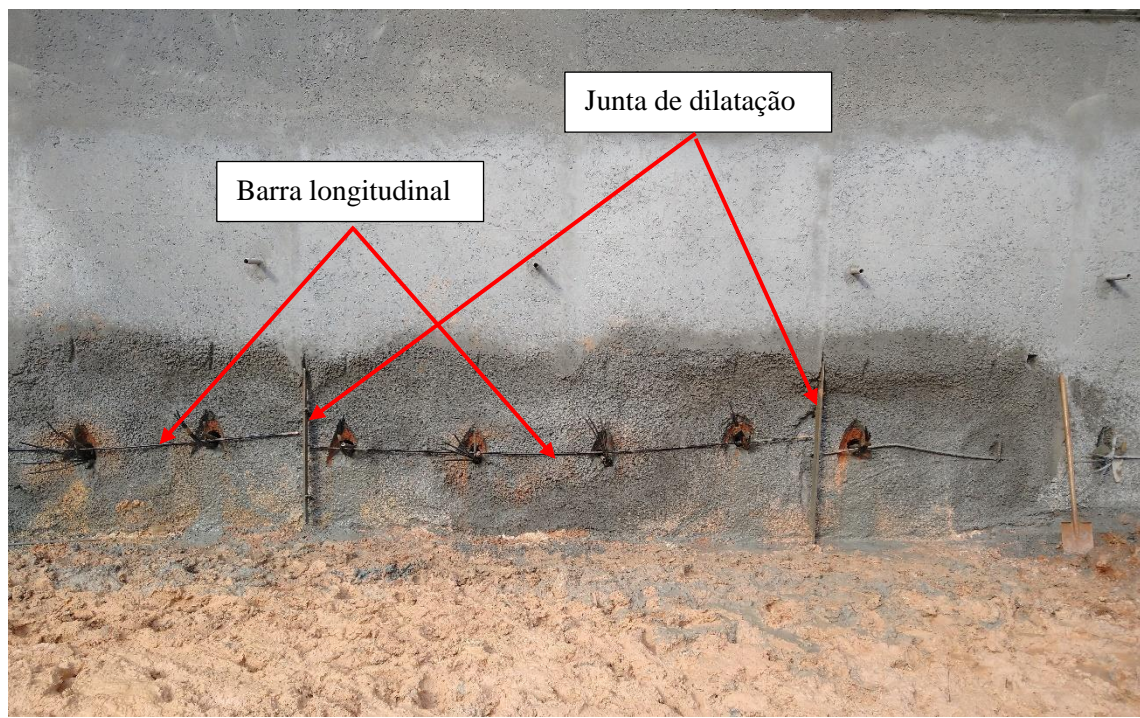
Linha de grampos subhorizontais executada, barra longitudinal instalada e marcação das juntas de dilatação
